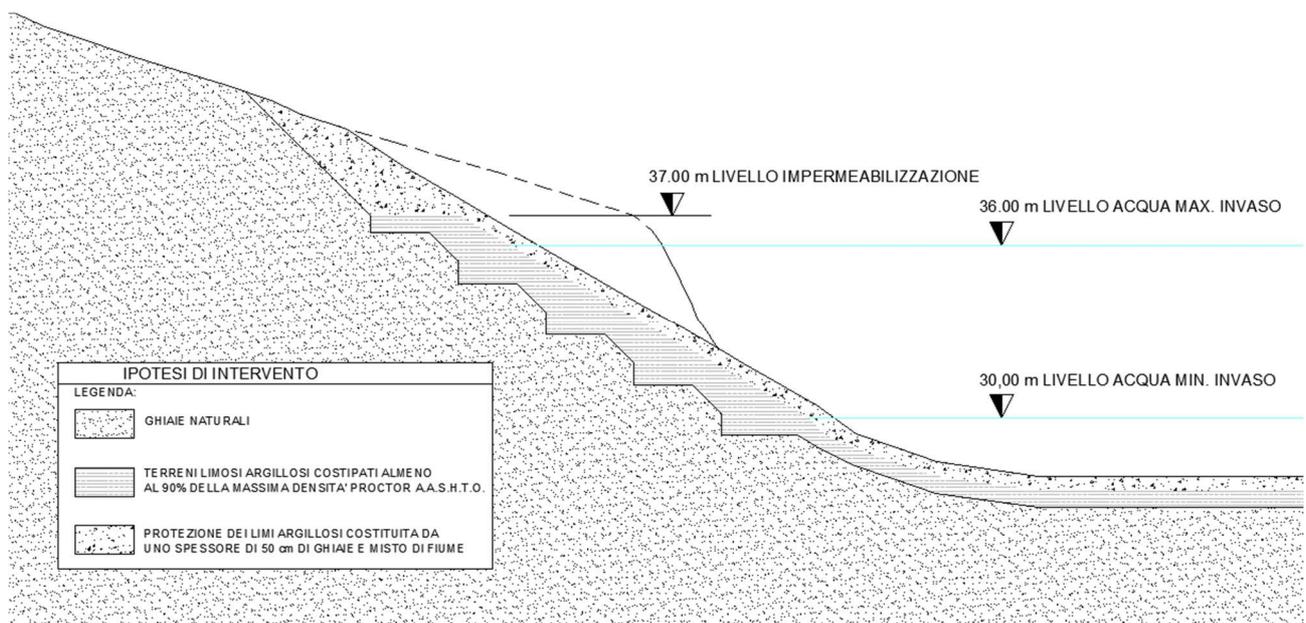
Sezione tipo opere di impermeabilizzazione del lago Azzurro
